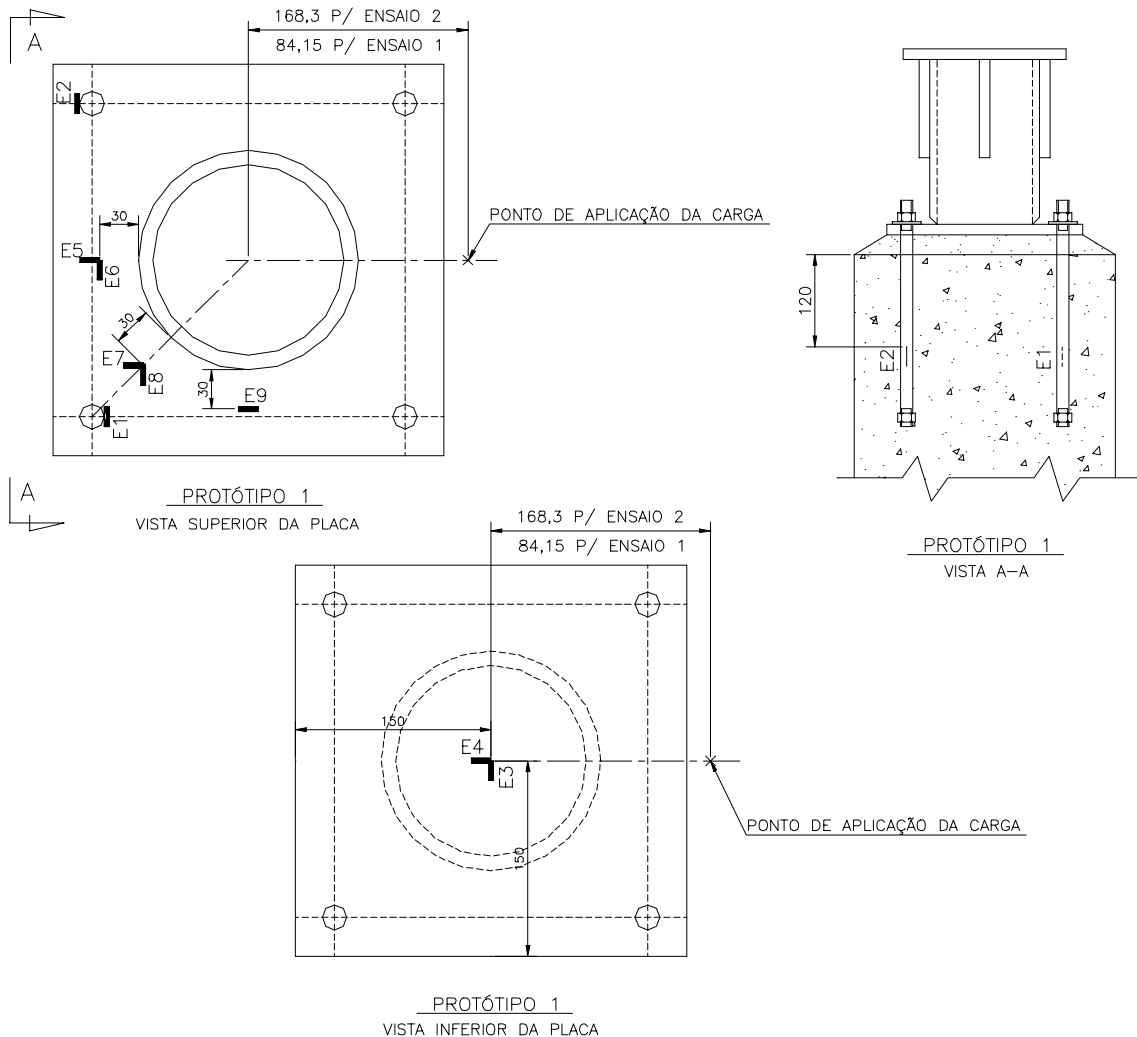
Detalhe do esquema de instrumentação com extensometria utilizado nos Ensaio 1 e 2.
